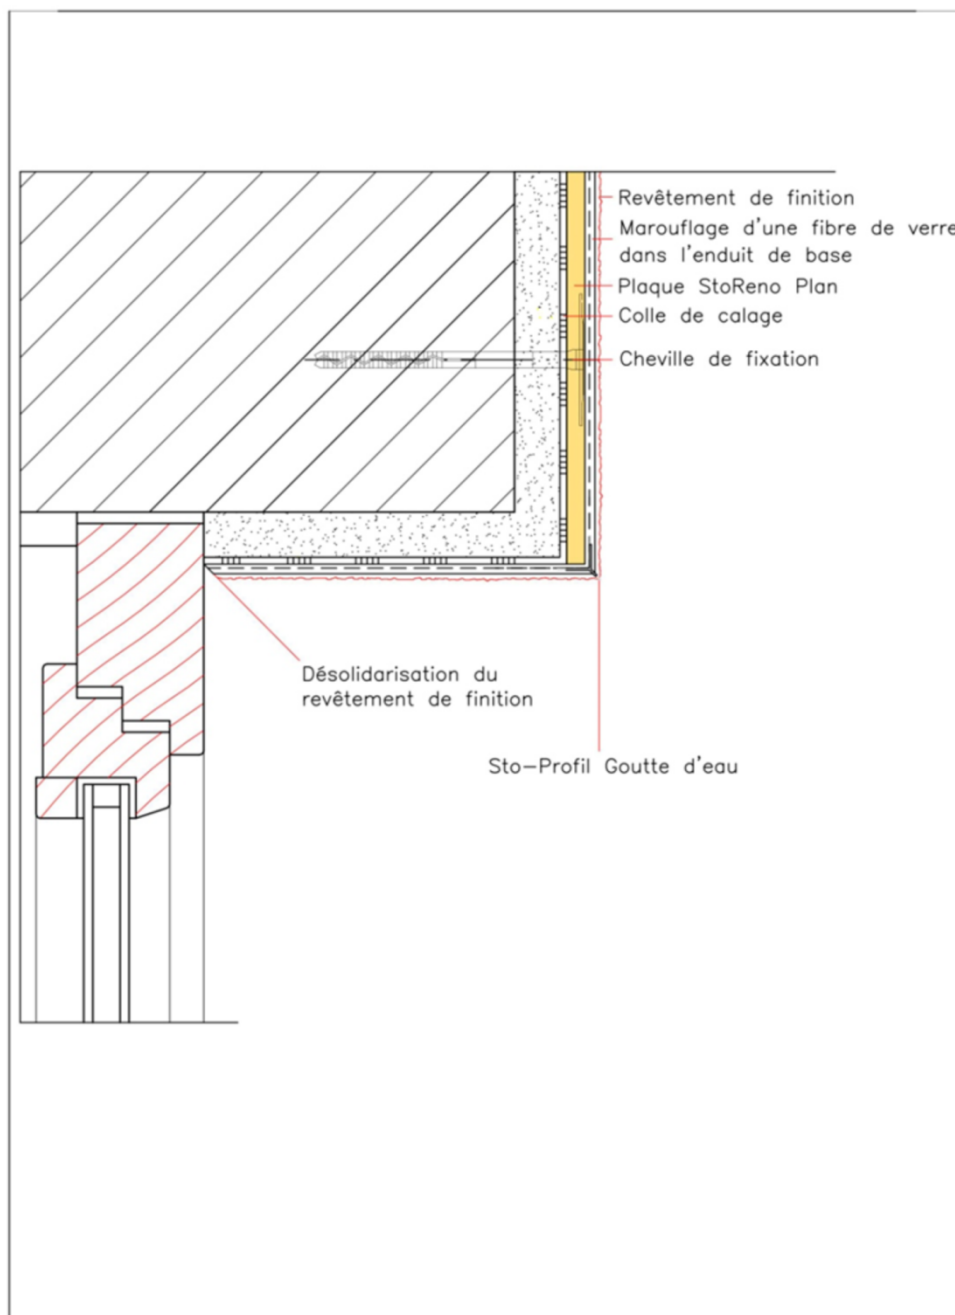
er : Arrêts horizontaux tablettes et linteaux de fenêtre
